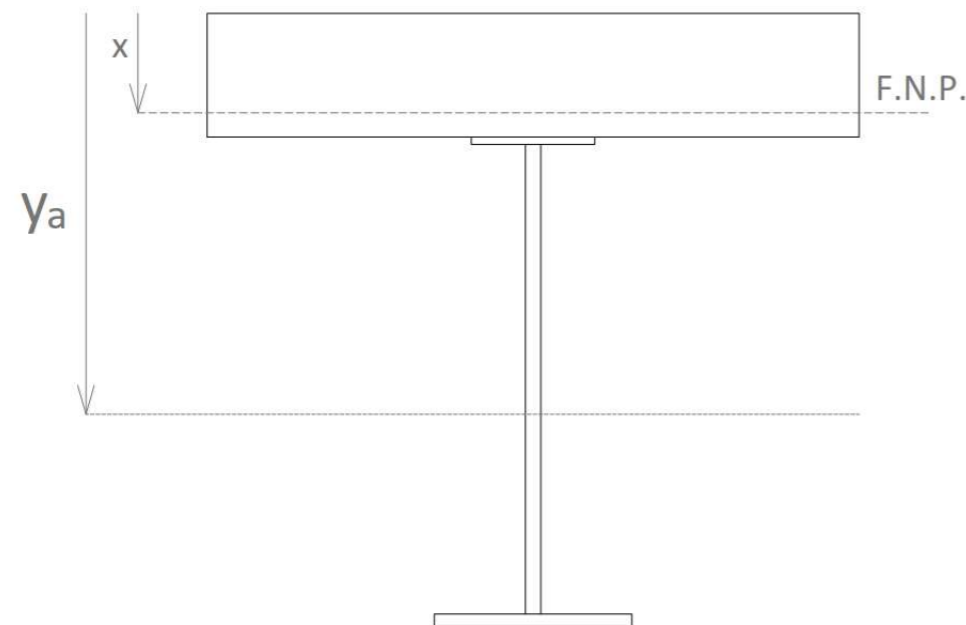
Fibra neutra plástica en la losa de hormigón de la viga transversal (fuente: elaboración propia)
